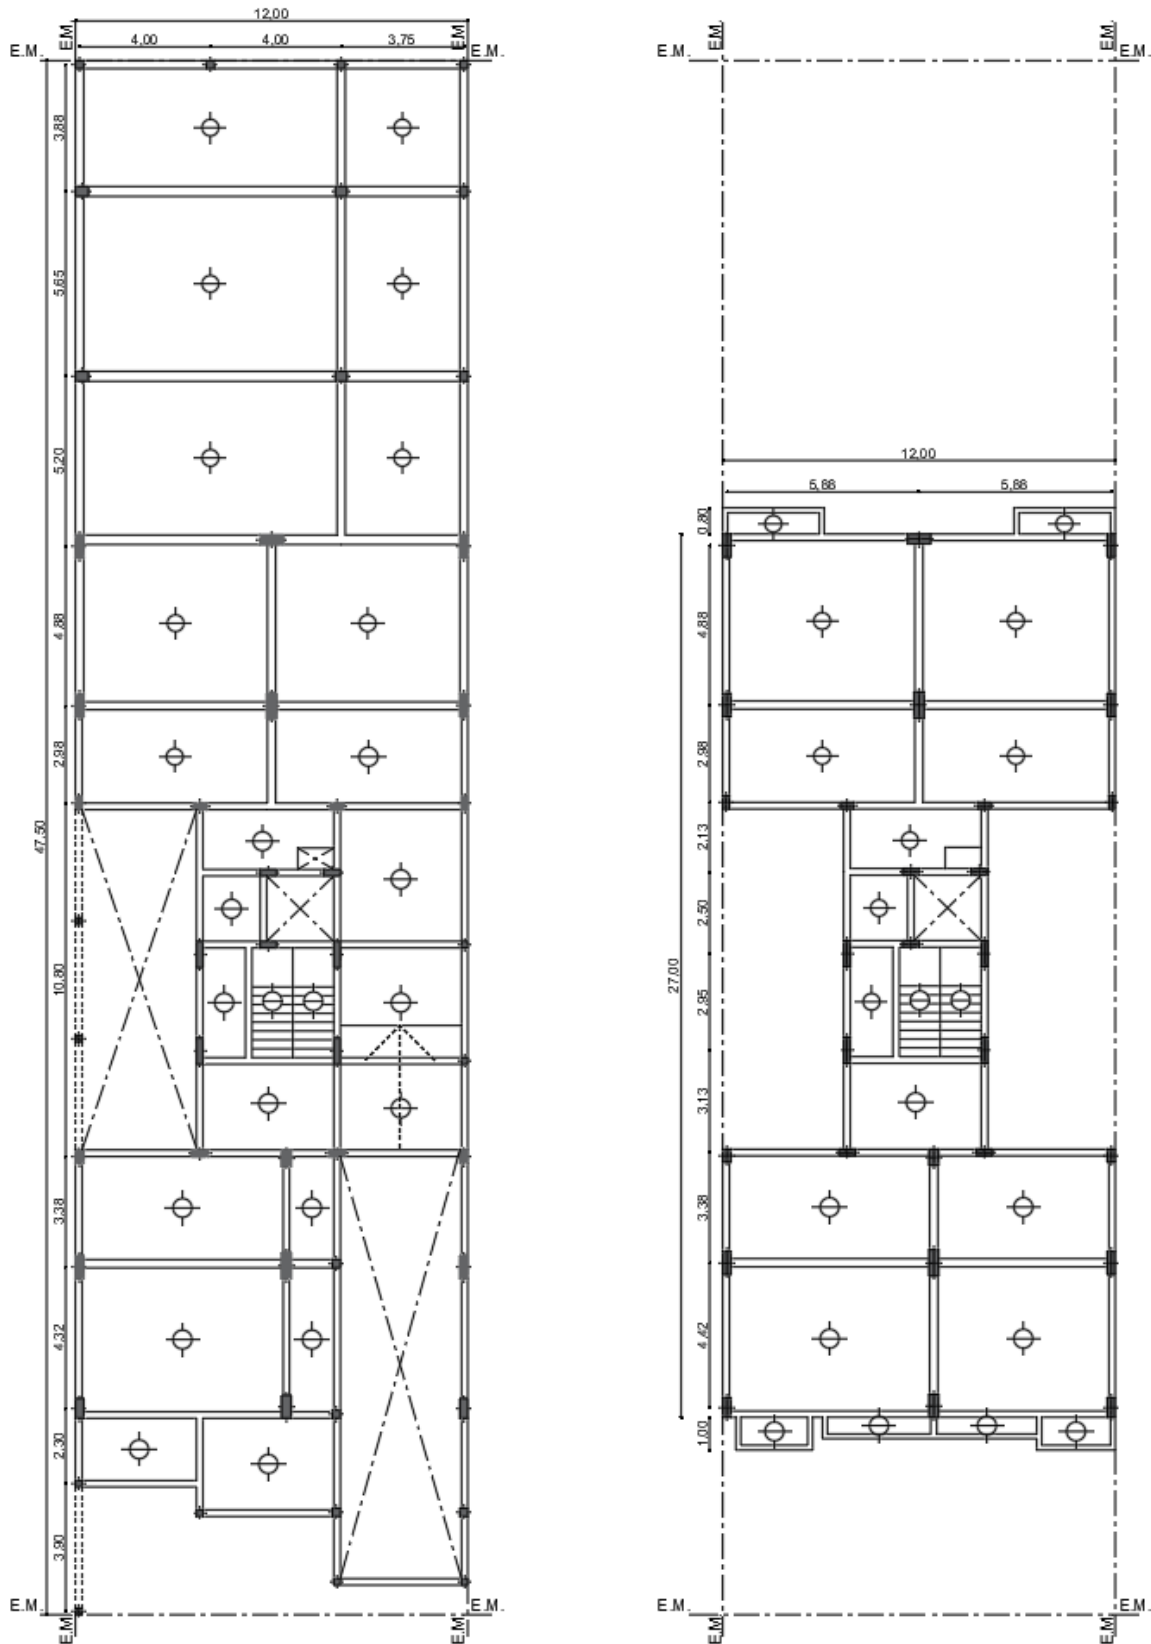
Planta de la estructura. Izq: 1er piso - Der: 3er piso
